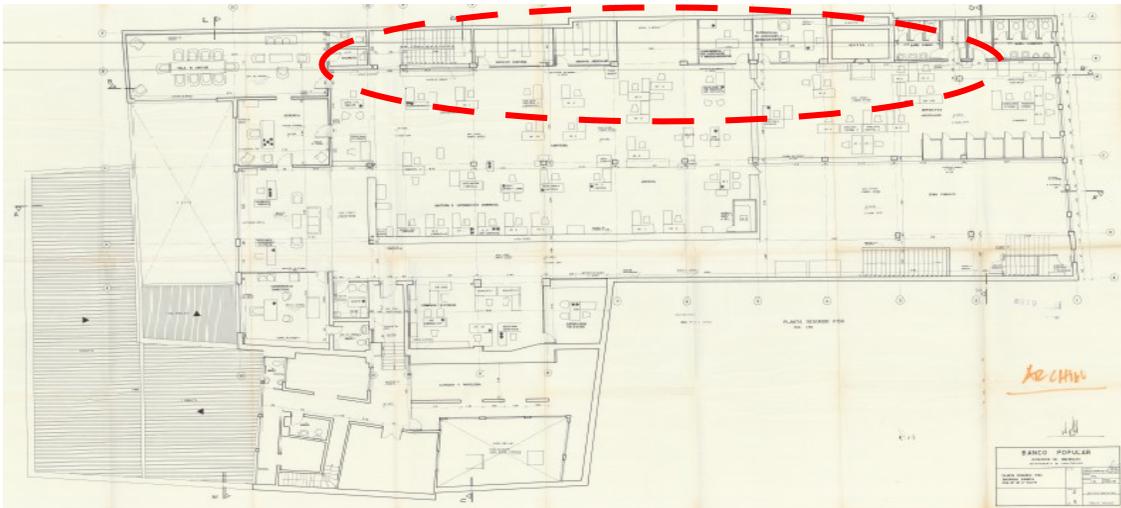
Fuente: Planimetría en archivo del IDPC correspondiente al inmueble ubicado en la carrera 8 11 73/75/77
